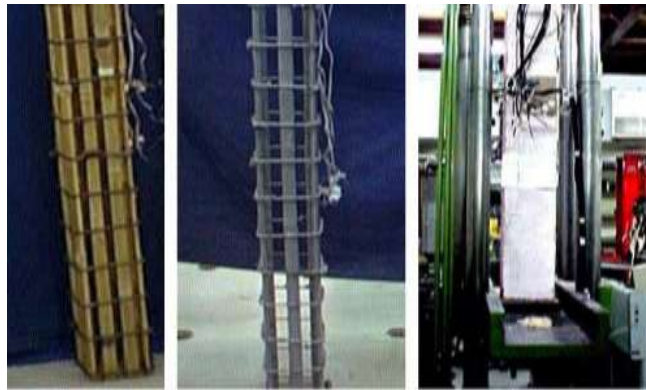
Ensaio dos Pilares armados com bambu [30]
